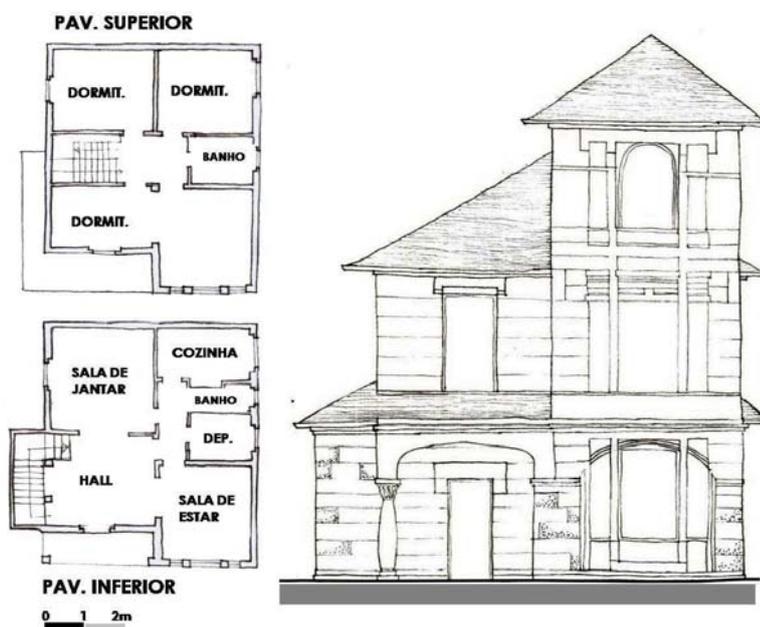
Casa de Salvatore Caronia: fachadas e plantas baixas.
